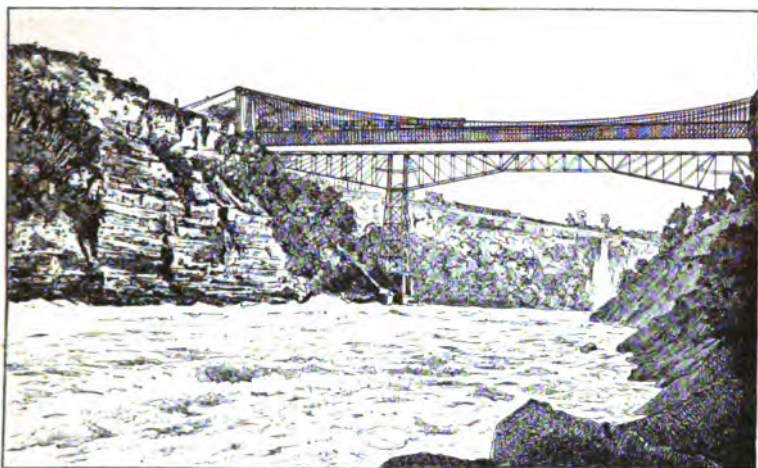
Pont suspendu et Pont Cantilever sur la Rivière de Niagara.
